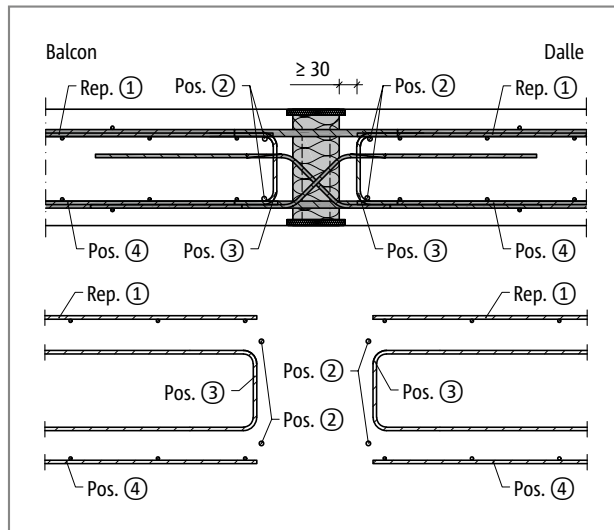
Schöck Isokorb® T Type D : Renforcement sur site
